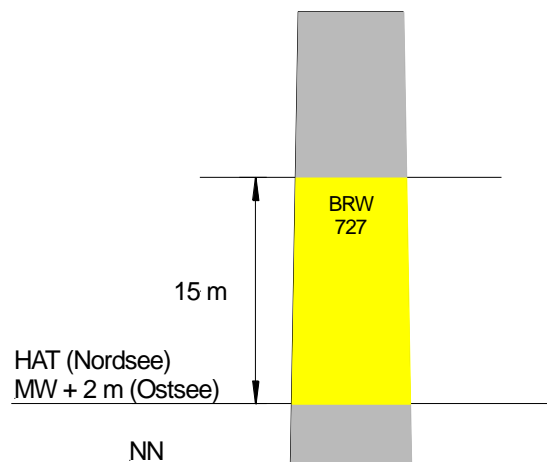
Beispiel einer Tageskennzeichnung mit Anstrich und Beschriftung
